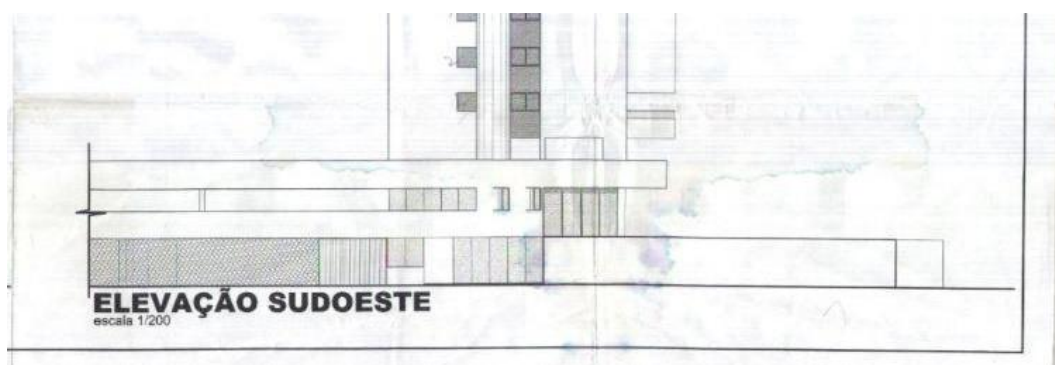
Detalhe da elevação sudoeste do Edif. Terra Brasilis, do arquiteto Bruno Ferraz, 2005. Fonte: Arquivo da Prefeitura do Recife (2005).
